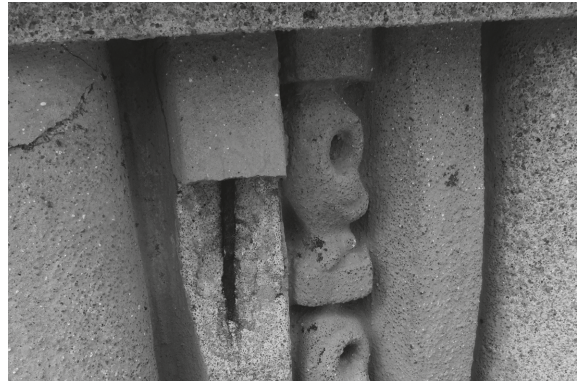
Fissuração e destacamento de argamassa em estátua por corrosão dos varões metálicos, 2010
